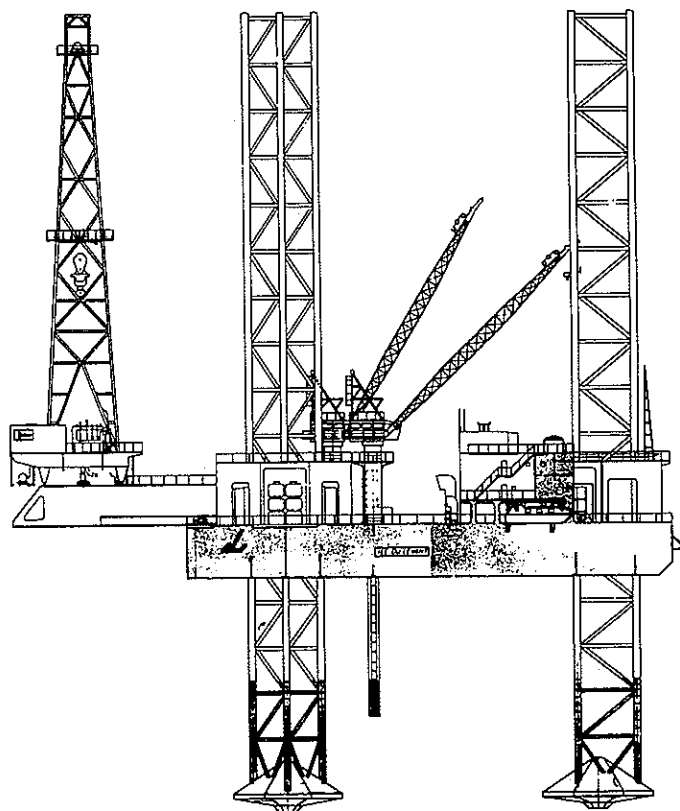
Plate-forme autoélevatrice (jack-up) (Source : Forasol).
